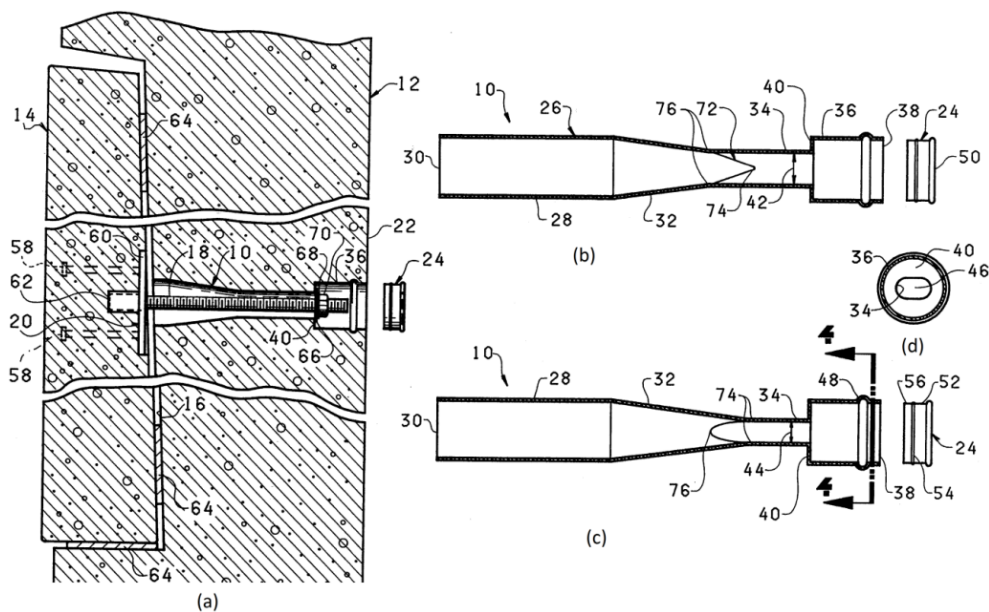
Luva conectora para ligação entre vigas e pilares em estruturas de CPM (a) vista geral da ligação, (b) vista lateral, (c) vista superior e (d) vista frontal (corte 44). [BAUR; KEISER, 1995].
